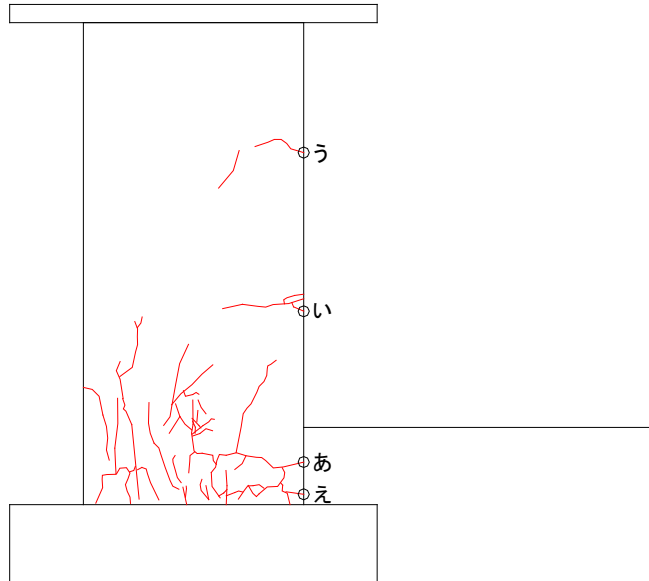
柱ひび割れ幅測定位置(試験体 A-5 負荷荷)
